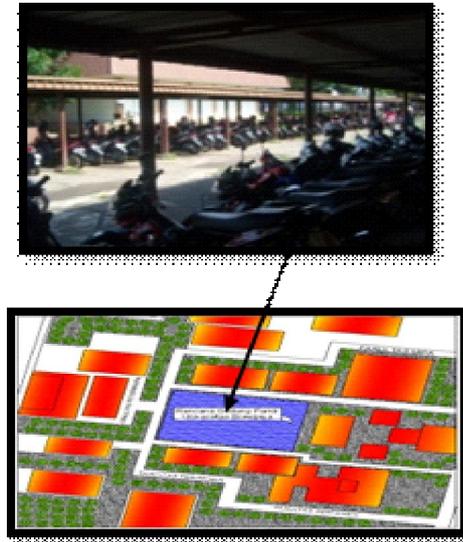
RencanaLahan Area Gedung Parkir Baru
